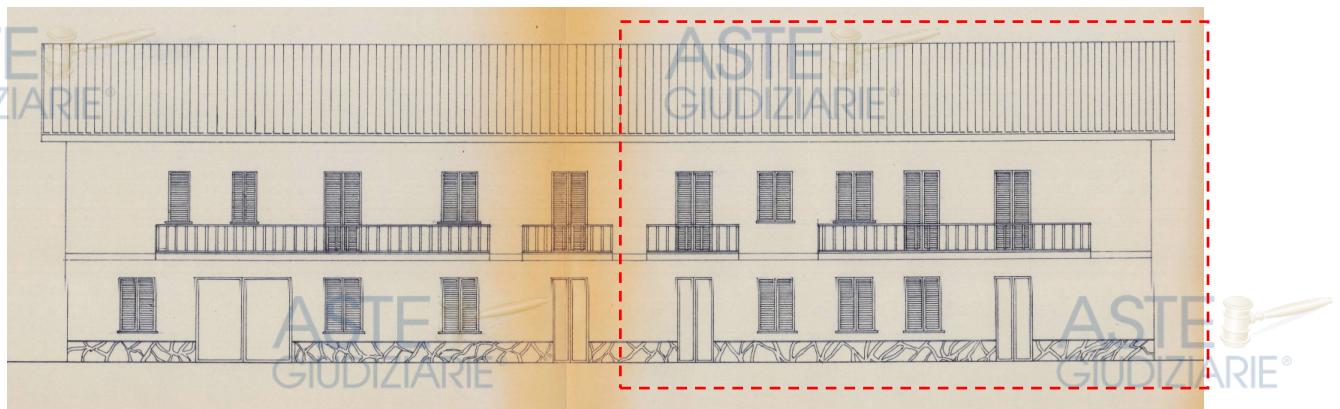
Estratto Concessione in sanatoria ai sensi della Legge 28/2/1985 n.47 prot. 20398
